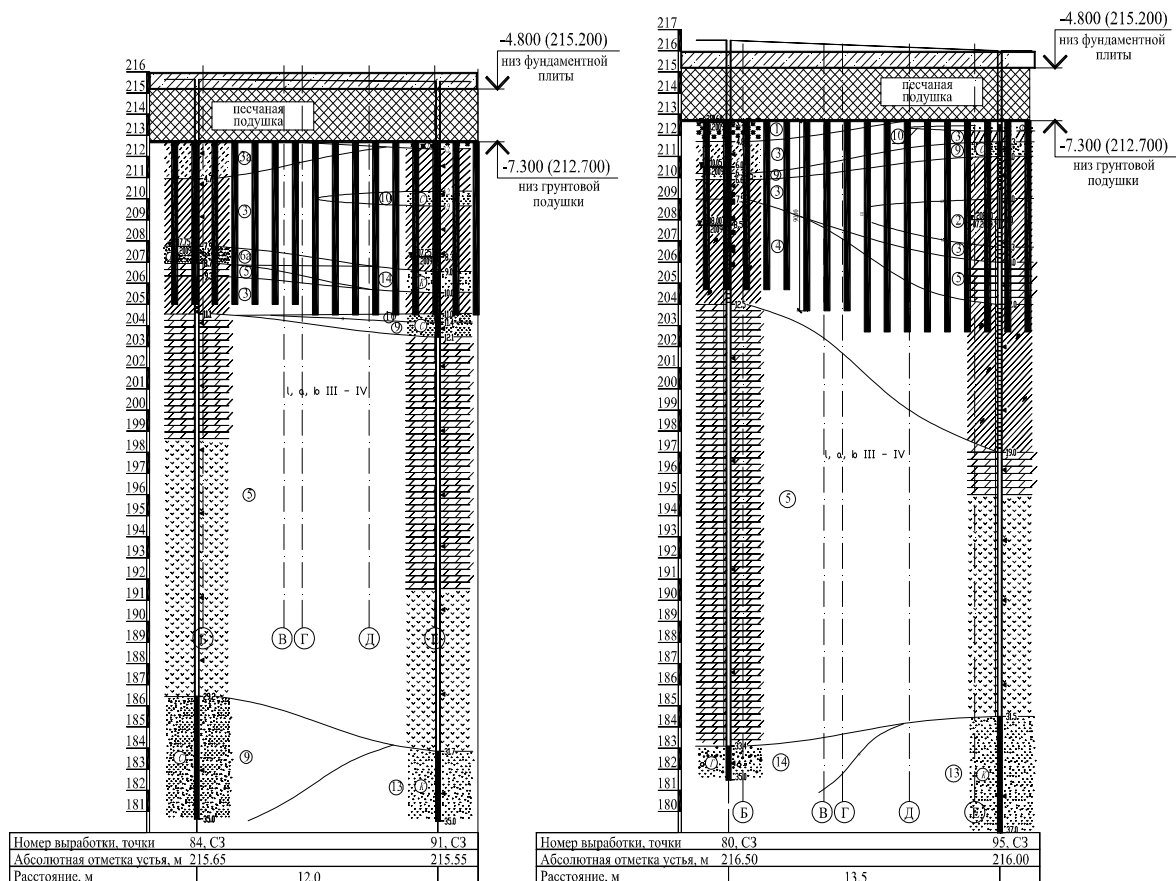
Характерные инженерно-геологические разрезы строительной площадки со вписанными элементами геомассива
